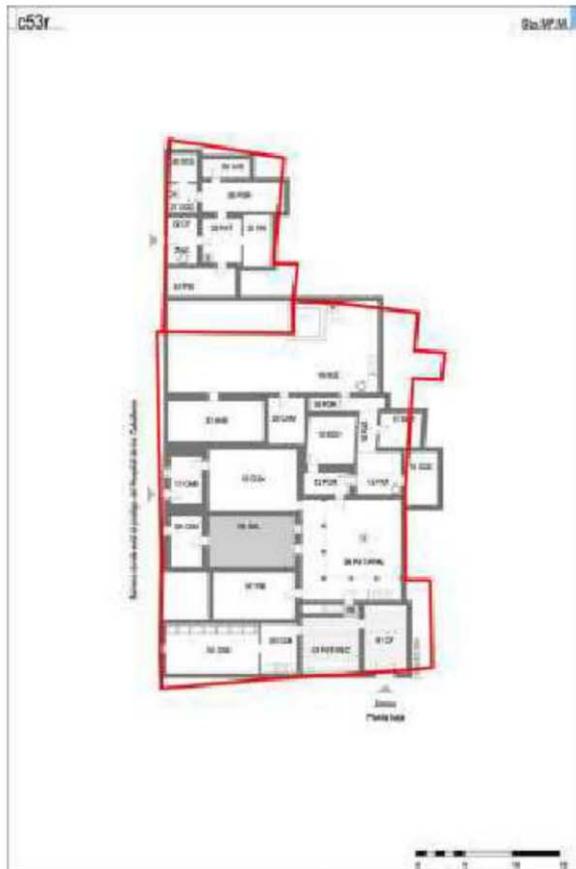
Dibujo en planta baja de la casa c53r según el apeo literario. En rojo, parcela catastral actual. Autor: M. Núñez
